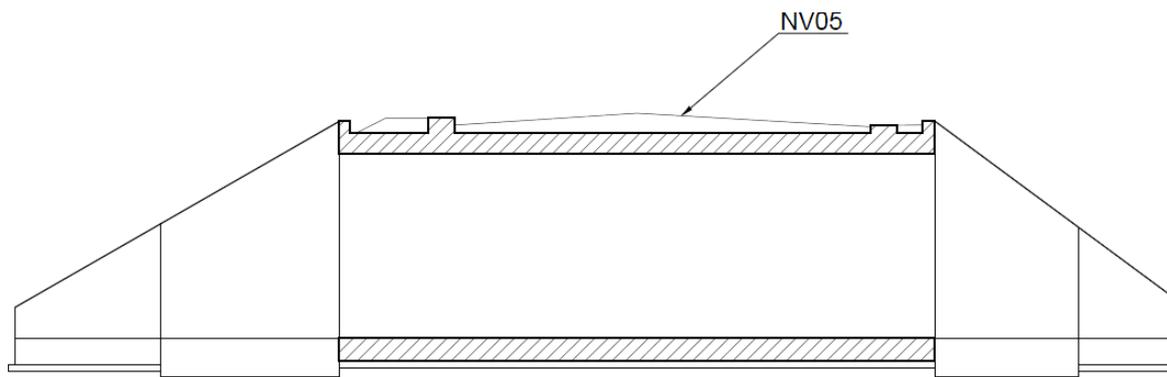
Profilo longitudinale scatolare con indicazione della strada
